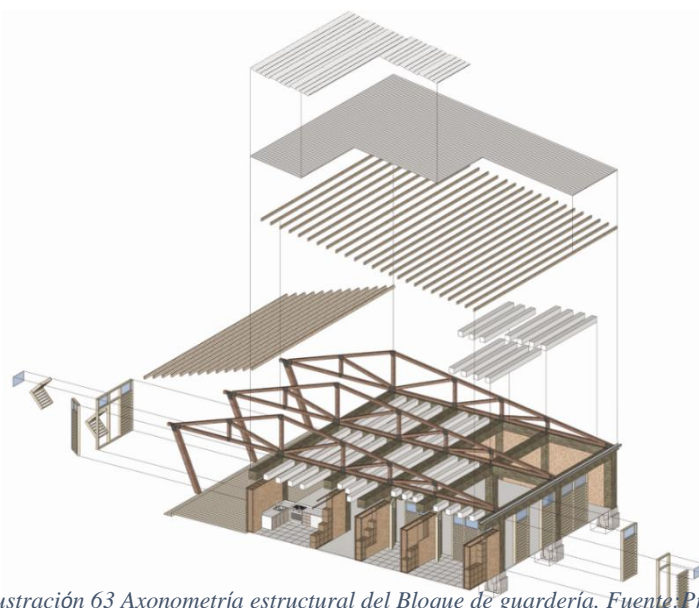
Axonometría estructural del Bloque de guardería. Fuente: Propia
